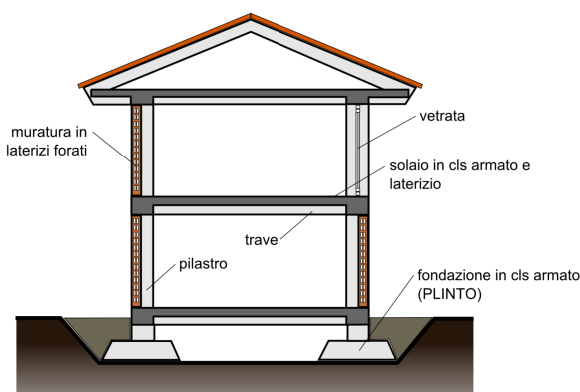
Sezione di un edificio ad ossatura in cls armato; osserva i pilastri e le travi perfettamente collegate tra loro.
